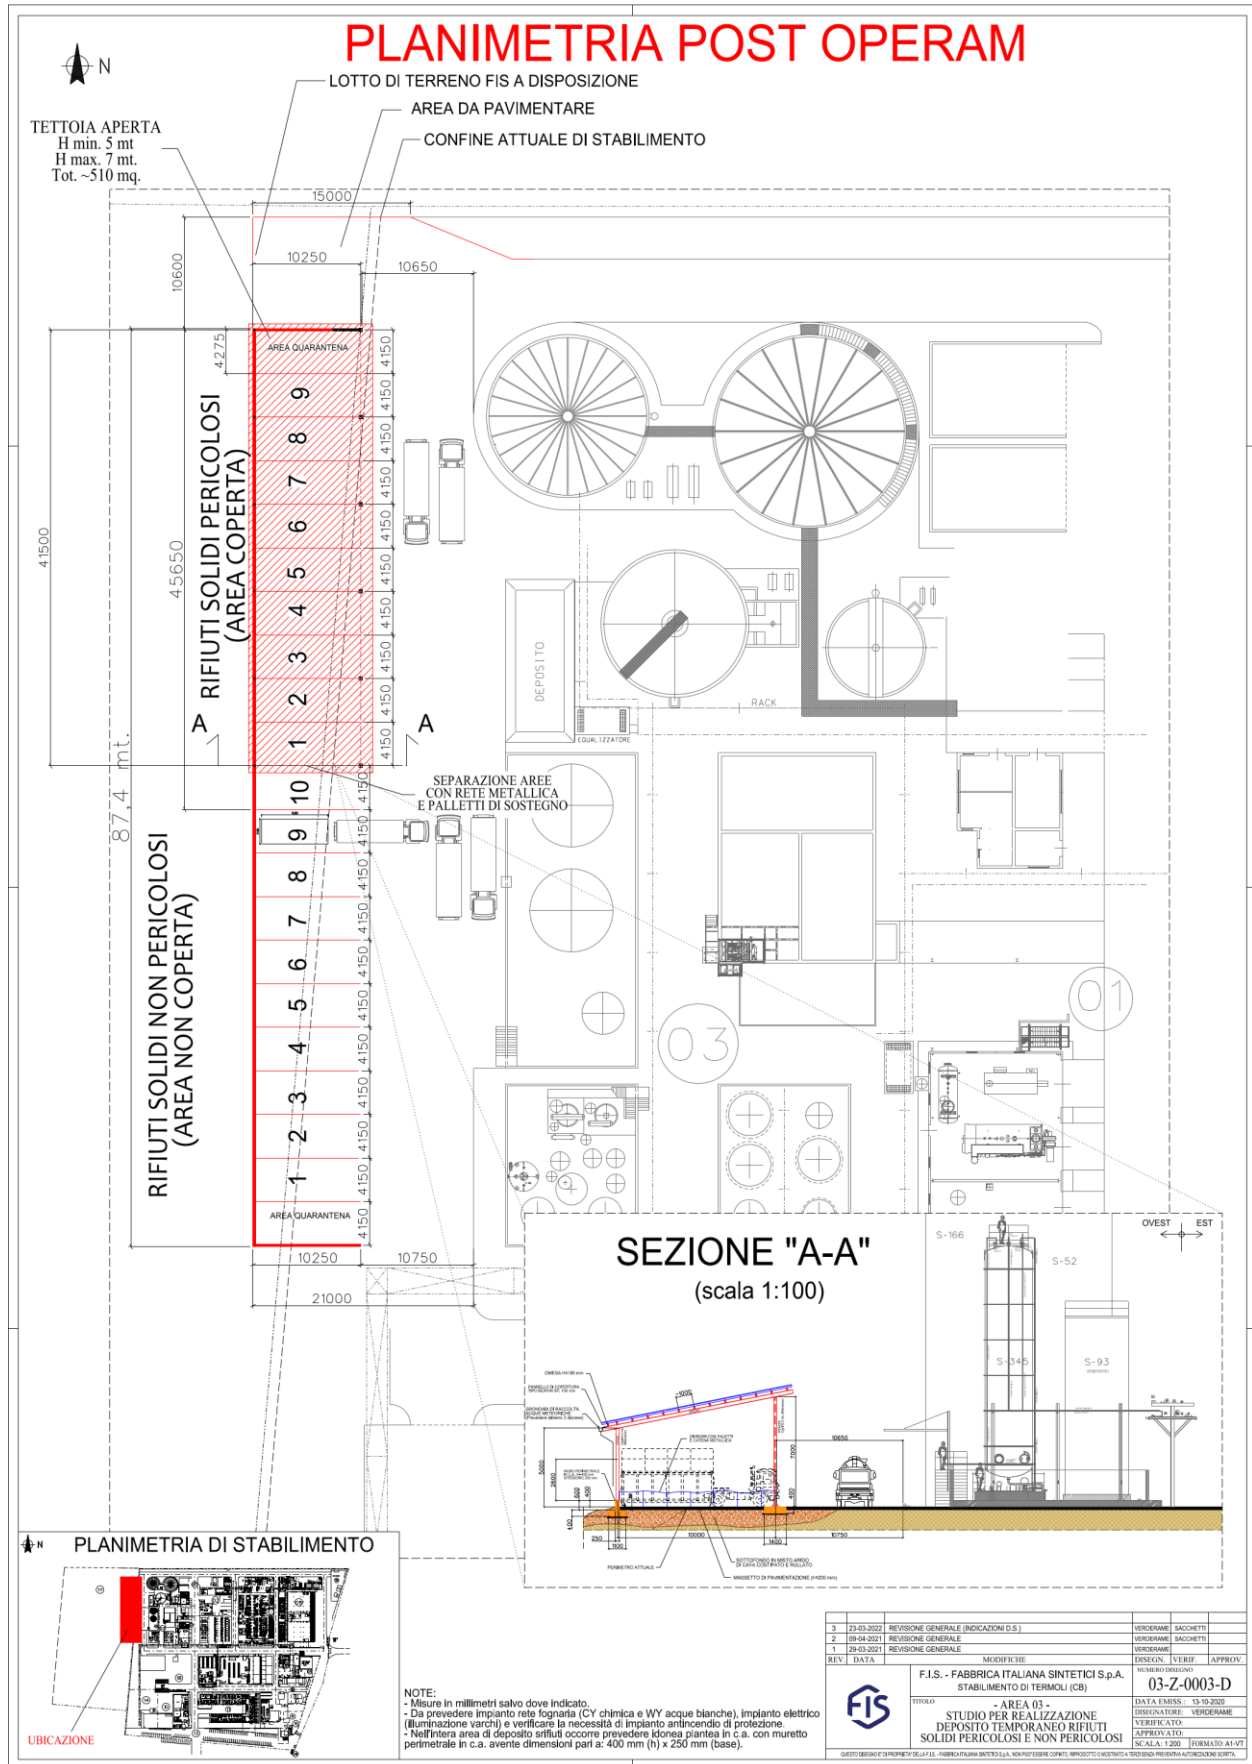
planimetria generale di stabilimento con indicazione delle zone di svolgimento del deposito temporaneo rifiuti: assetto "post operam"
